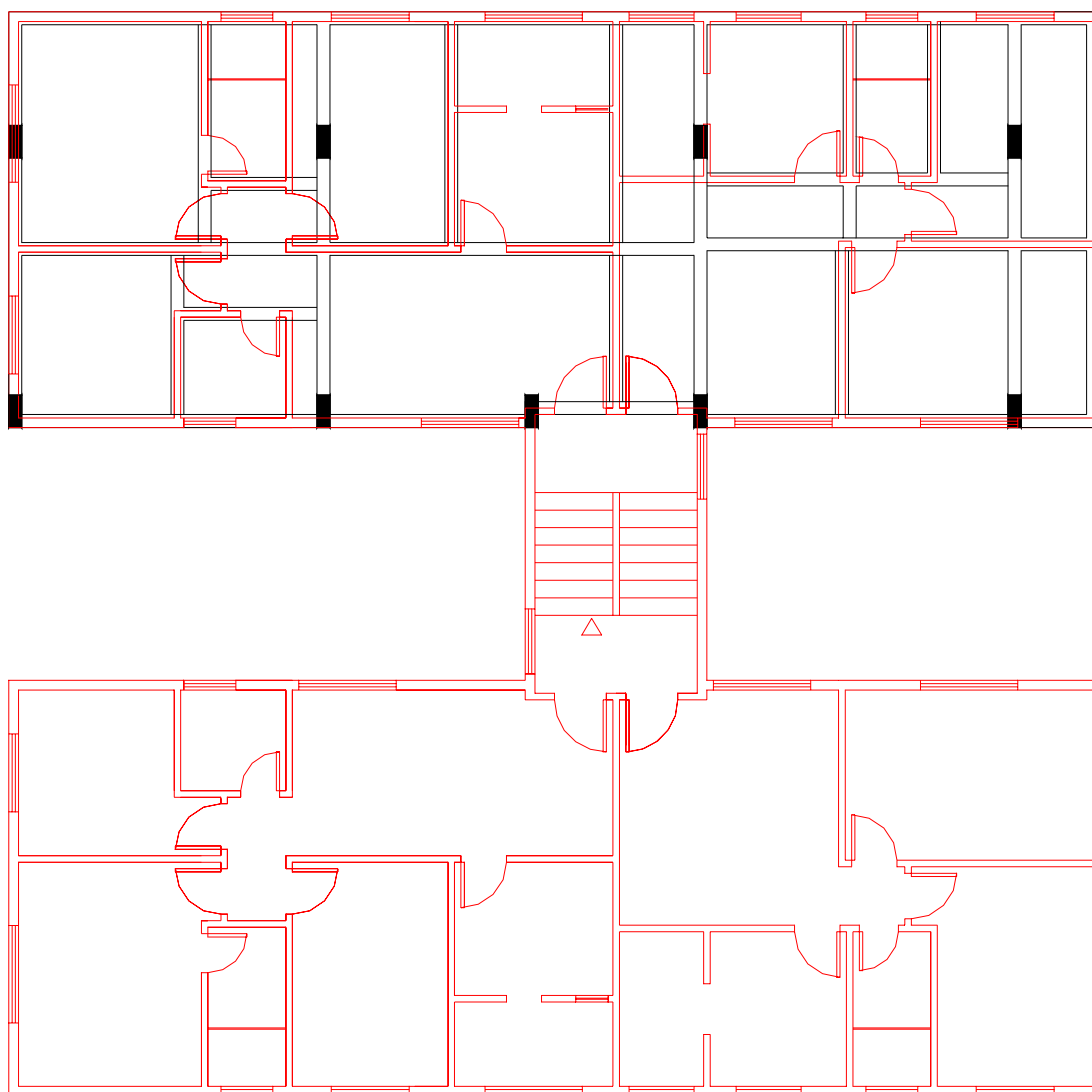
Residencial “S” – Superposição das alvenarias do pavimento tipo sobre a segunda solução de vigamento do pilotis
